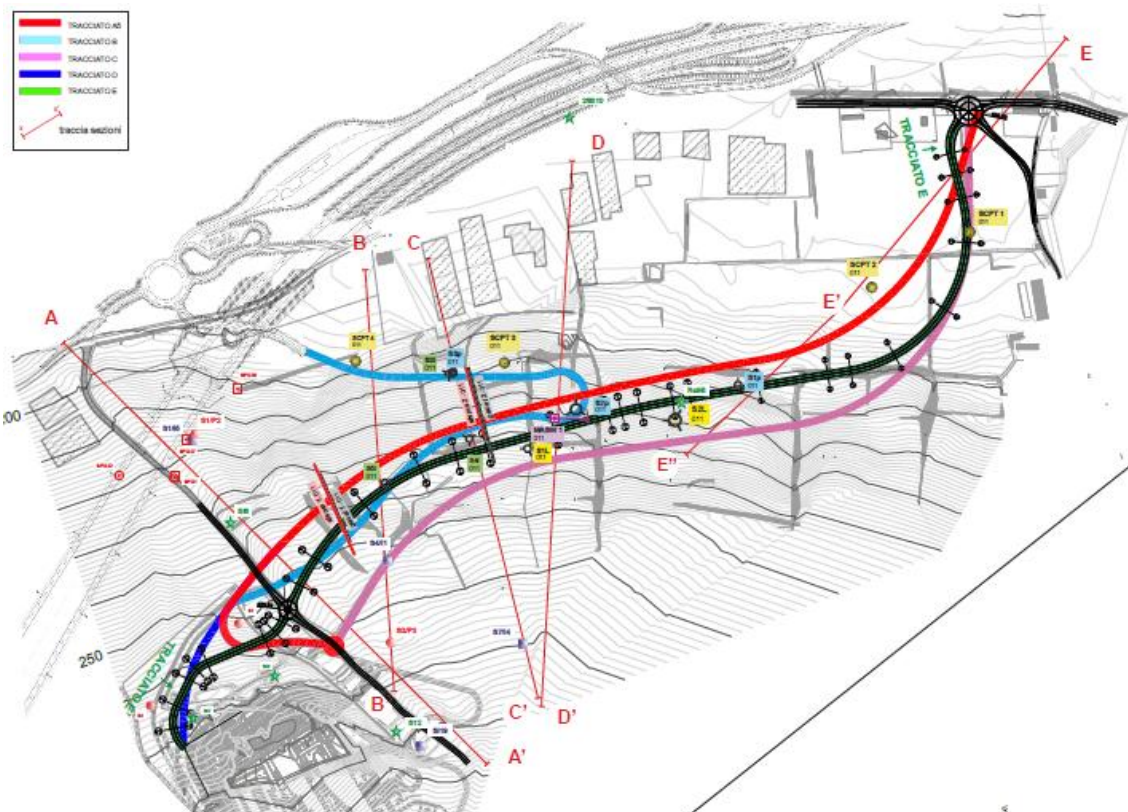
Stralcio planimetria con le ipotesi di tracciato stradale e la traccia delle sezioni geologiche
